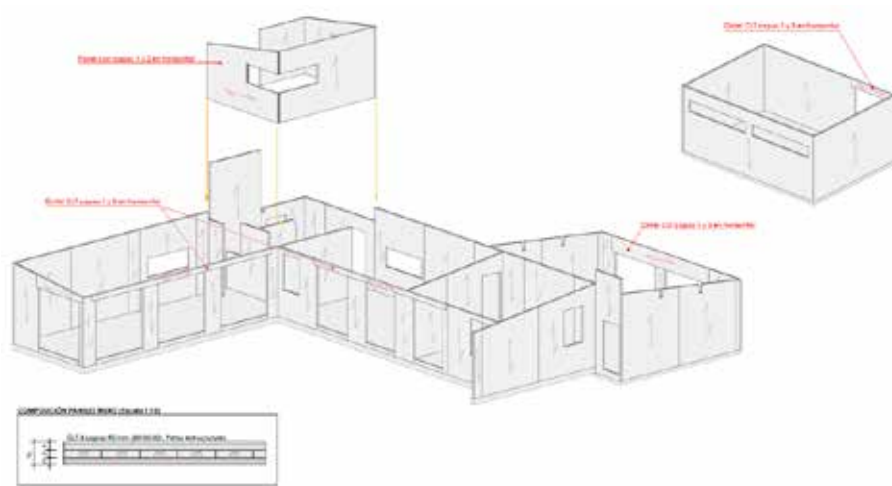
Modelo 3D del proyecto en CLT de una vivienda unifamiliar en Biduido, Ames, de la arquitecta Marta Trigás, construida por EDM Casas y CLT suministrado por Xilonor. Este modelo ha sido desarrollado por Escuadría utilizando Cadwork. En esta axonometría se indica la dirección de láminas de las caras exteriores mediante una flecha, y en el detalle, la composición del panel CLT de 3 capas.
